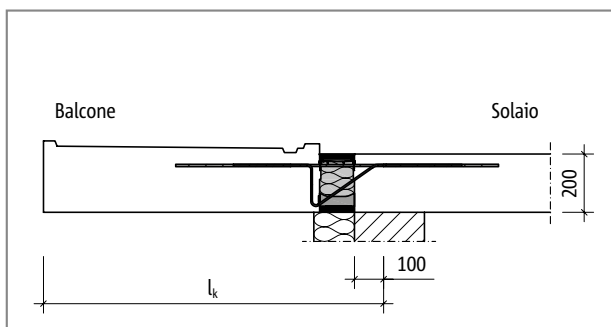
Schöck Isokorb® tipo KXT: schema statico
